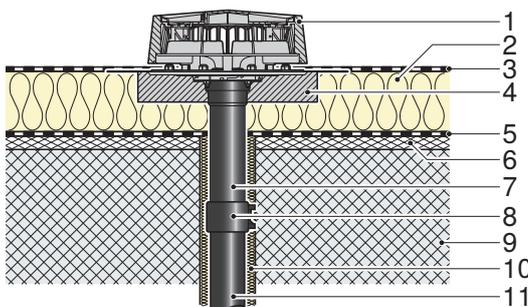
Монтаж на изолированной жесткой кровле с битумным кровельным покрытием
